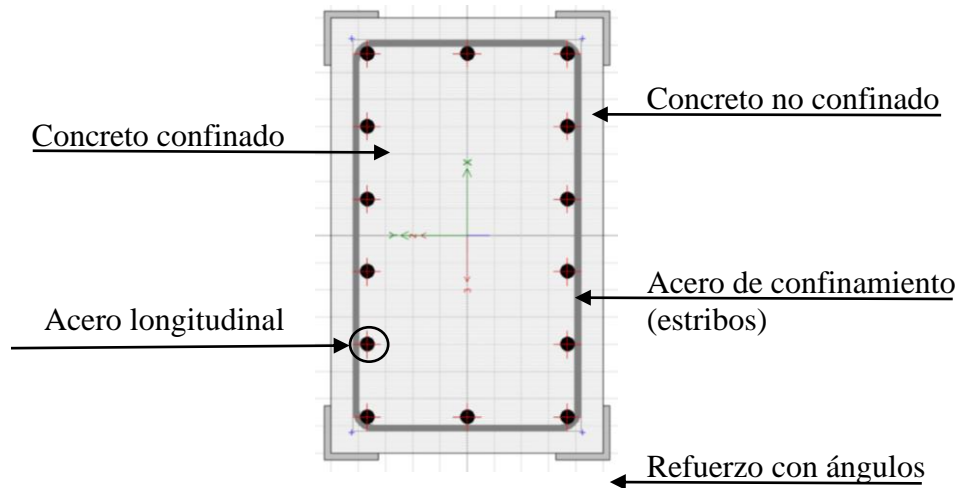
Sección transversal de columna definida a partir de un modelo de fibras.
